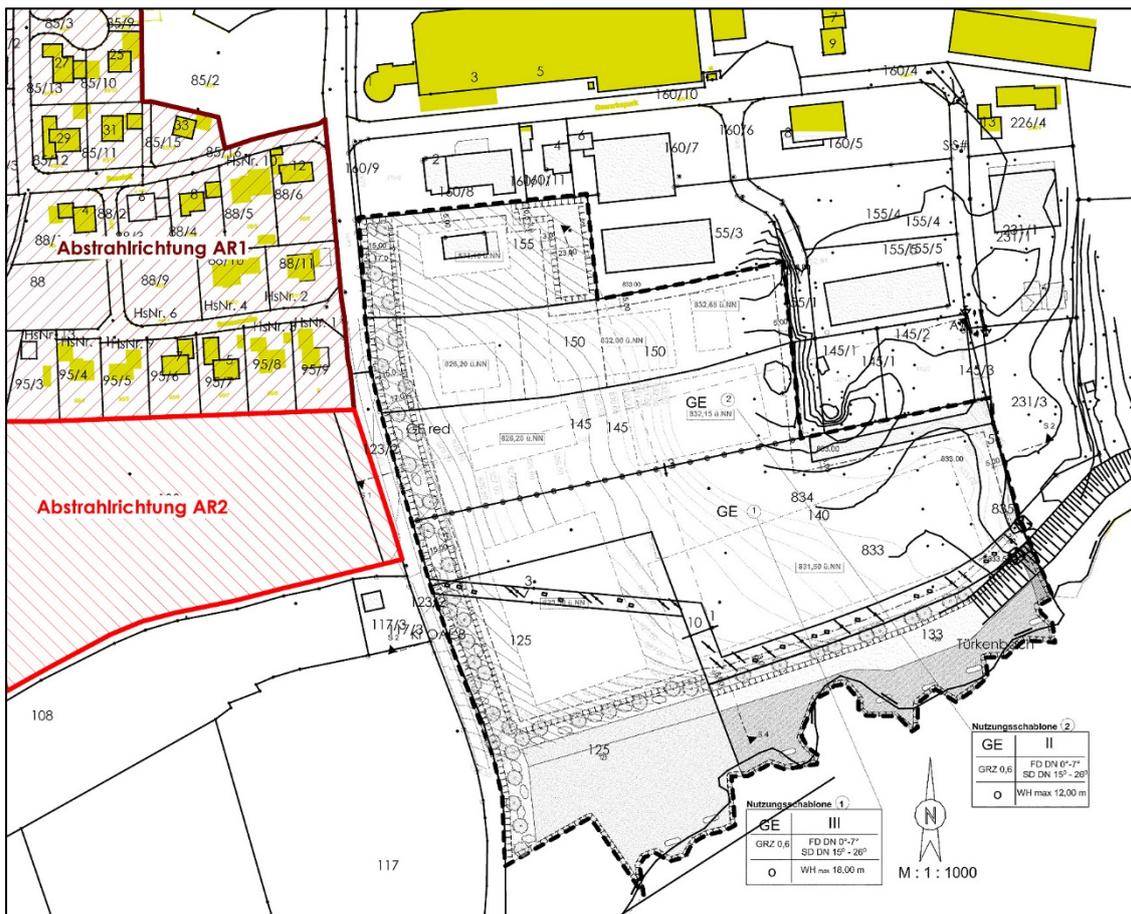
Lageplan mit Darstellung der Abstrahlrichtungen AR
